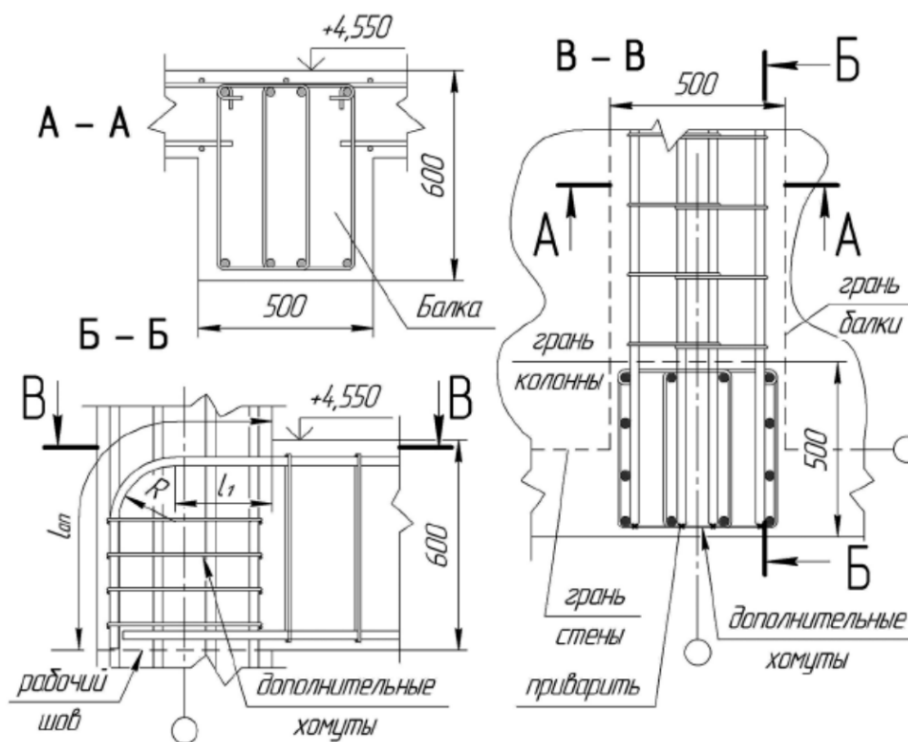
Узел сопряжения колонны и балки монолитного перекрытия
